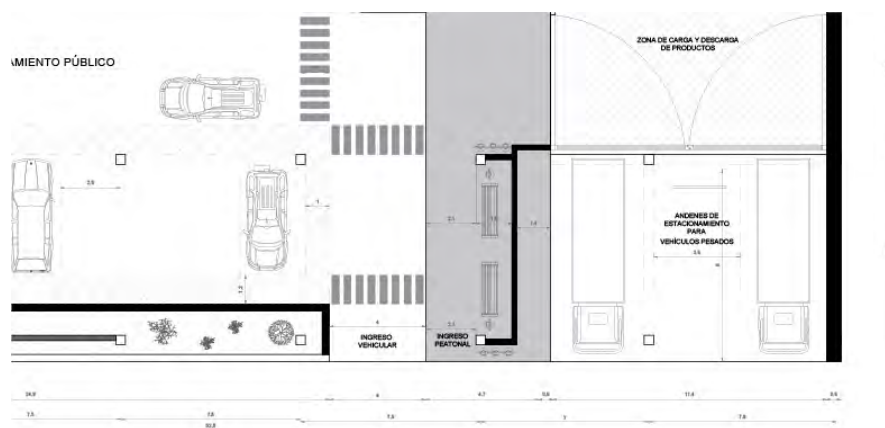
Estacionamiento público y Especial: dimensionamiento de las baterías o zonas de aparcamiento. Fuente: El Autor.
